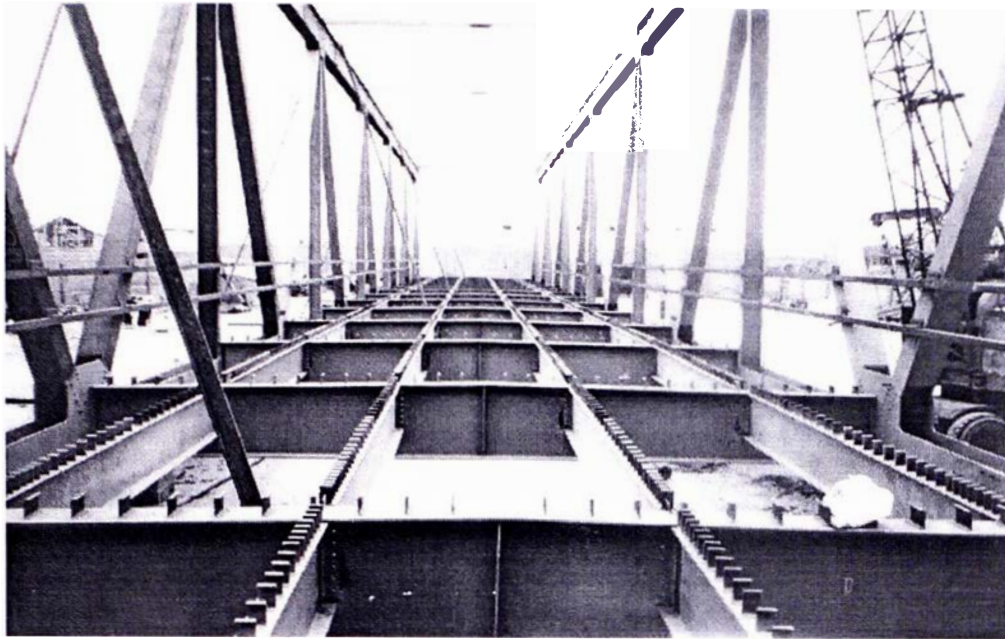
Ensamblaje de la Estructura Metálica Reticulada
